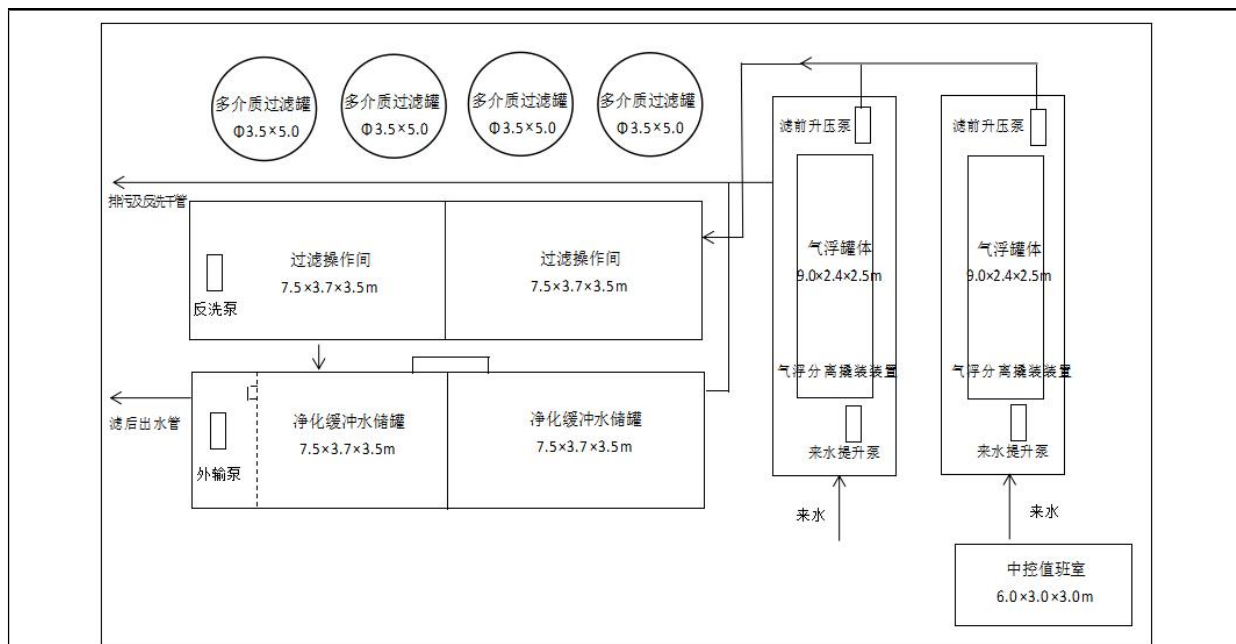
本次新建 2 套水处理撬装设备平面布置简图
